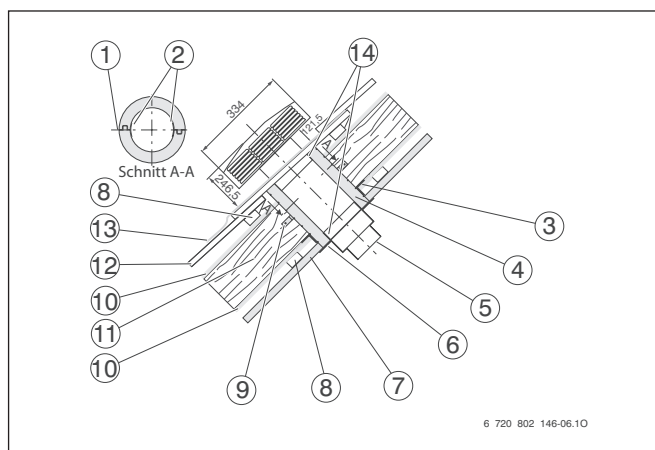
Wymiary przepustu dachowego DDF 160/1 (w mm)
